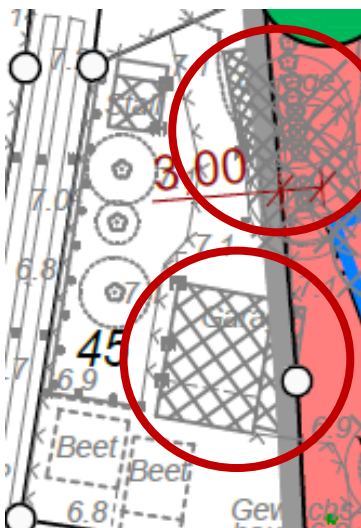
Auszug der Planzeichnung - westlicher Teilbereich, Flurstück 45
